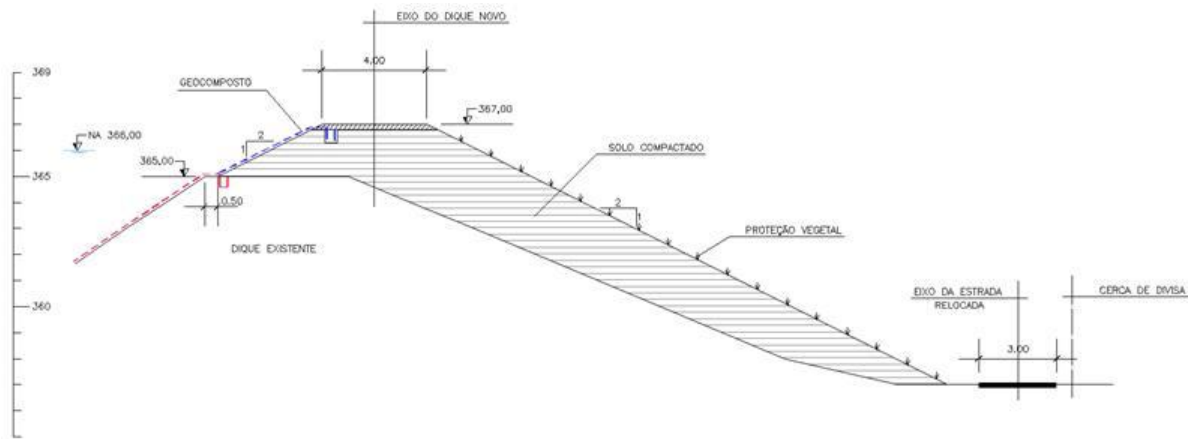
Seção típica do Lago III – Impermeabilização a montante com GM PVC 0,80mm
